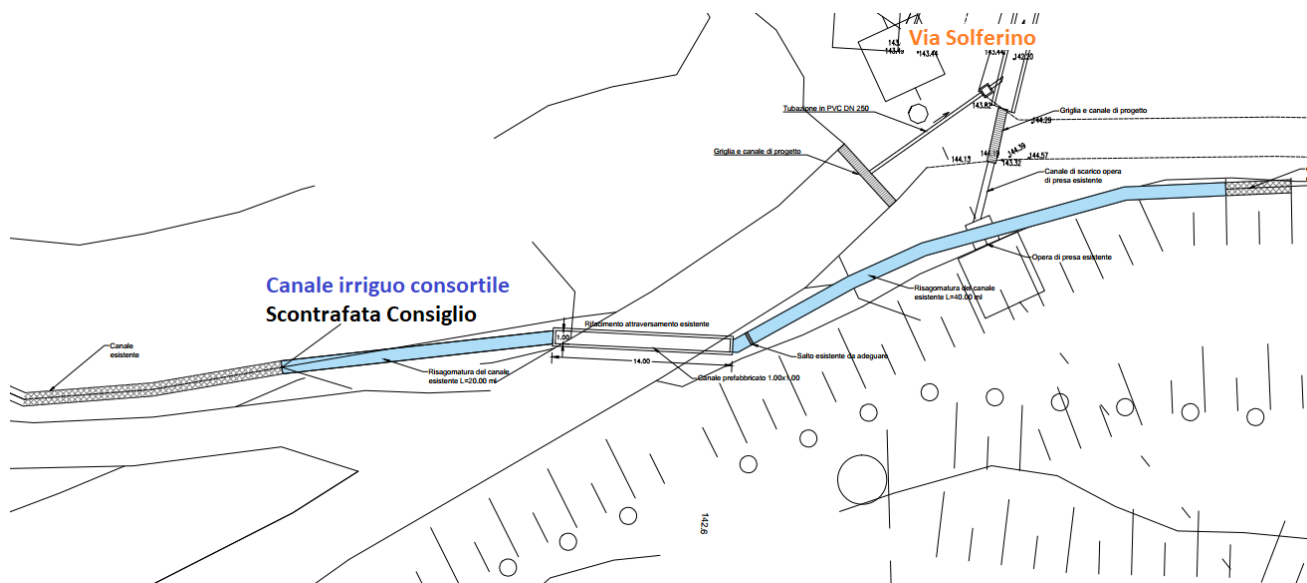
Stralcio planimetria di progetto - canale irriguo consortile Scontrafata Consiglio
